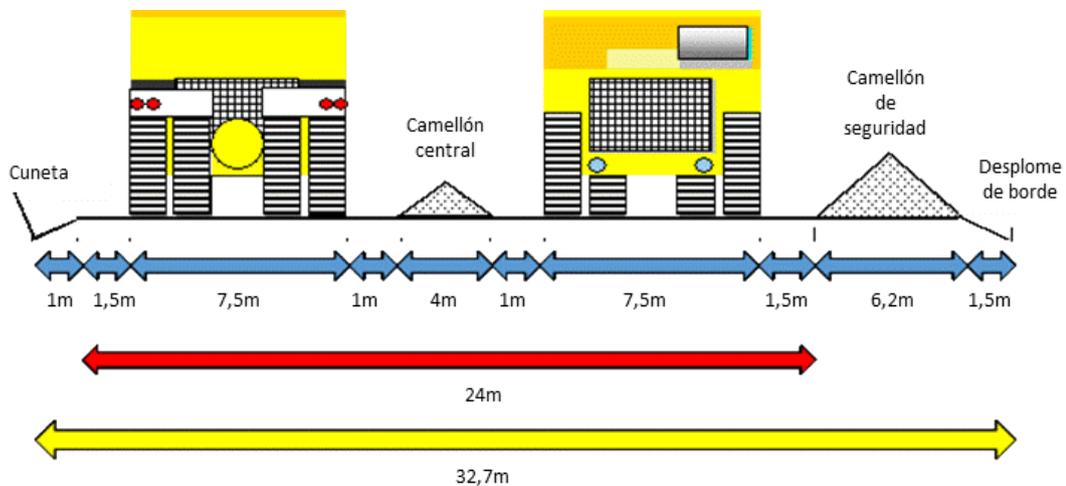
Ancho de camino de 2 pistas con camellón central
